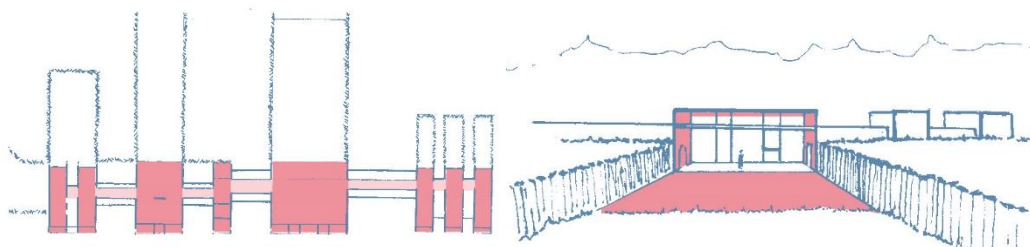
Planta y perspectiva Casa Horizonte. Elaboración propia.
